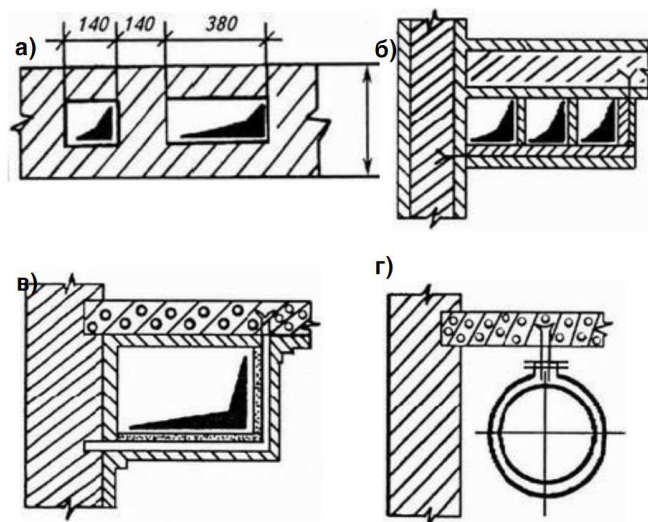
Воздуховоды: канал в стене (а); приставной вертикальный (б); подвесной горизонтальный (в); подвесной круглого сечения (г)
